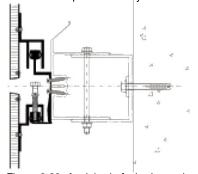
Anclaje de fachada ventilada de paneles honeycomb.
